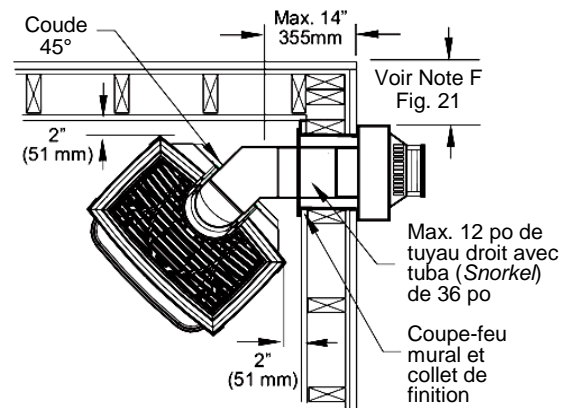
Installation dans un coin avec terminaison tuba (*Snorkel*) de 36 po.
